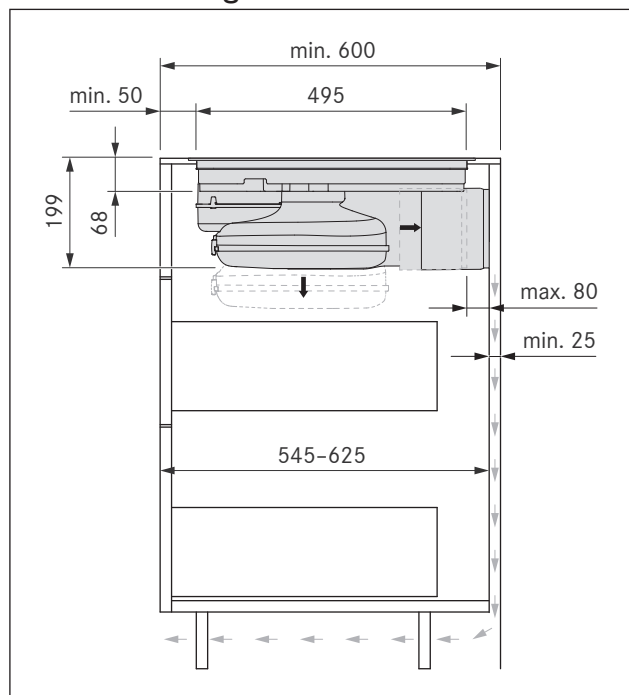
Cotes de montage pour l'air recyclé, profondeur du plan de travail 600 mm
